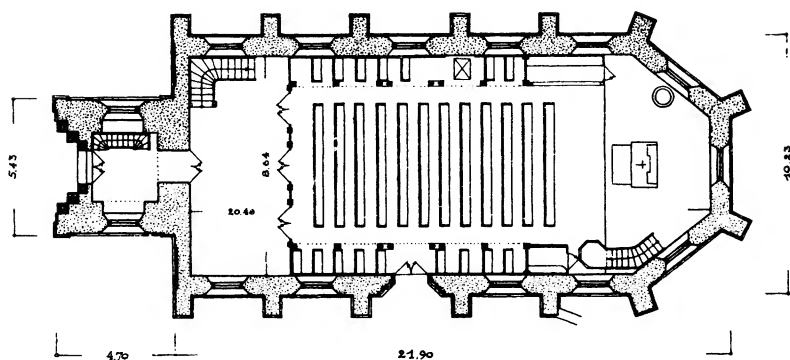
Dessau—Groß-Rühnau. Grundriß der Kirche (Maßstab 1:300)
